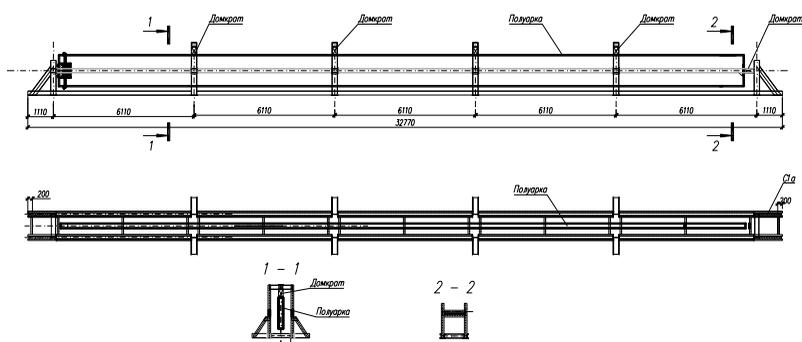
Установка для испытания в натуральную величину клееных деревянных балочных элементов арки треугольного очертания
